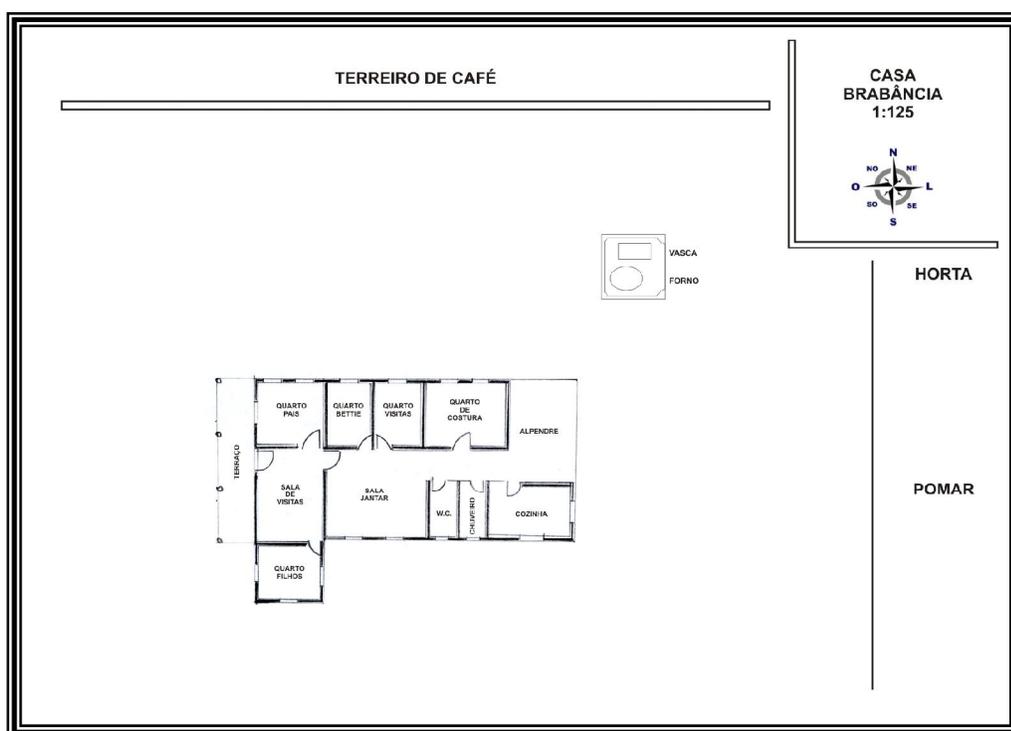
Planta baixa da sede da Fazenda Brabância nos anos de 1950.
